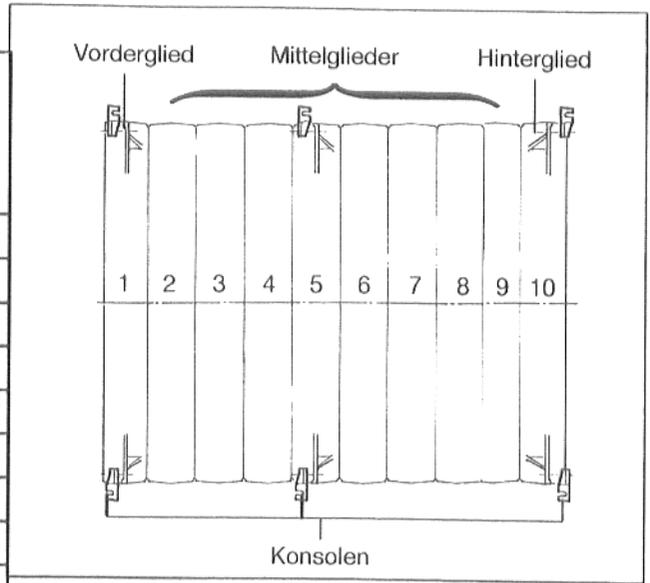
Draufsicht; Kesselblock 10 Gld. mit Konsolen
